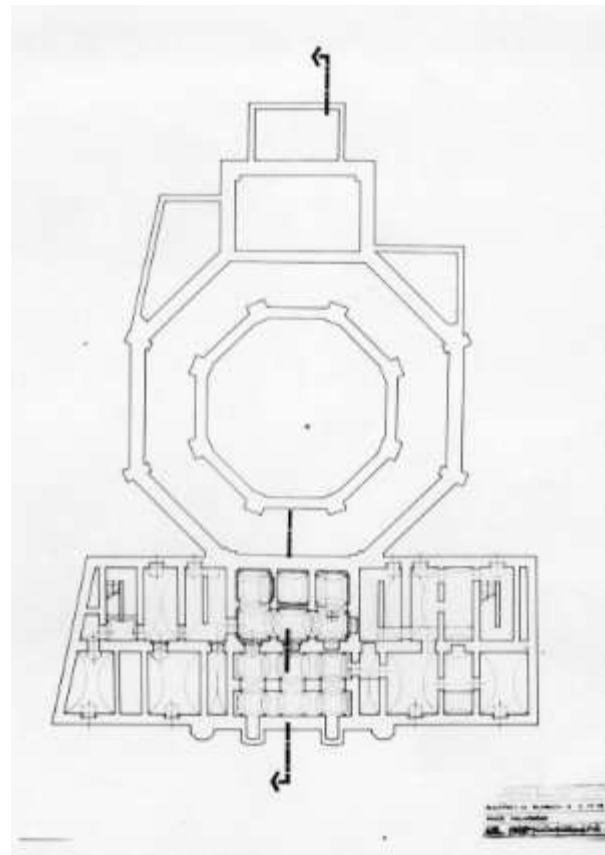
Grundriss Kellergeschoß Vermesserplan 1971
